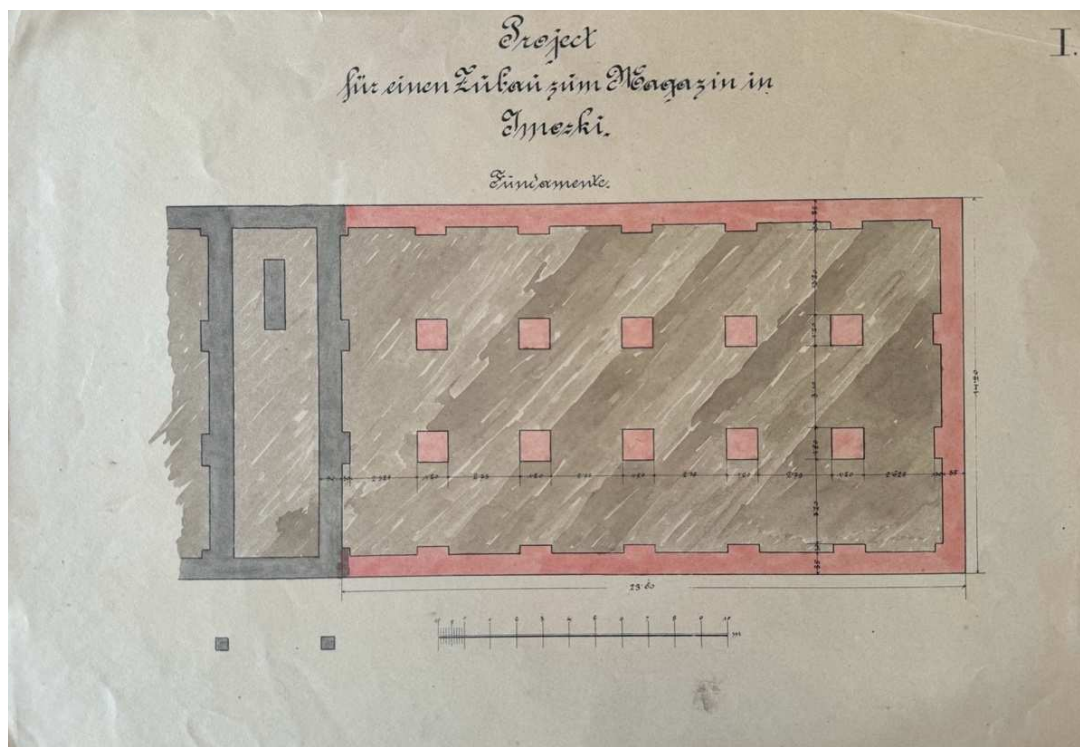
Projekt für einen Zubau zum Tabakmagazin in Imotski, Grundriss des Fundaments.
